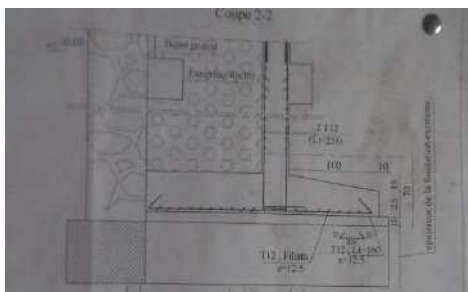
2 : Les détails constructifs, source : dossier graphique béton et béton armé reliée par l'ingénieur du BET
